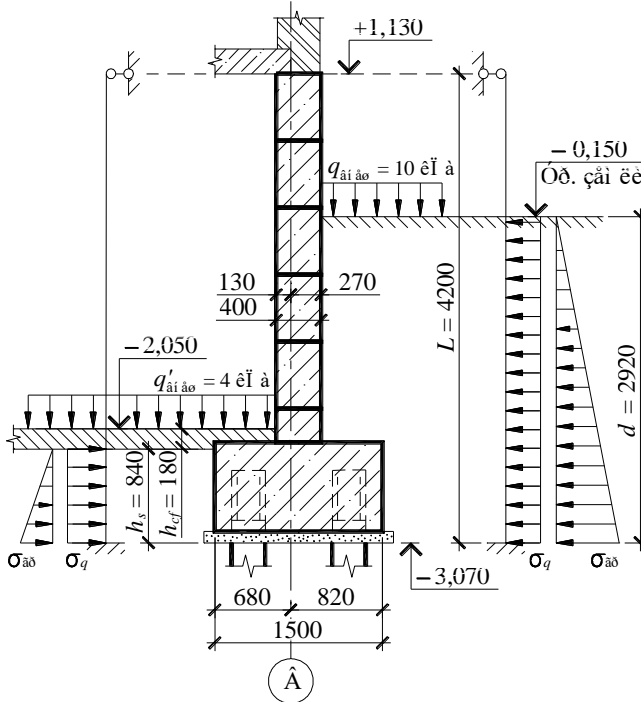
Схема действия бокового давления грунта на стену подвала для ростверка РЗ
